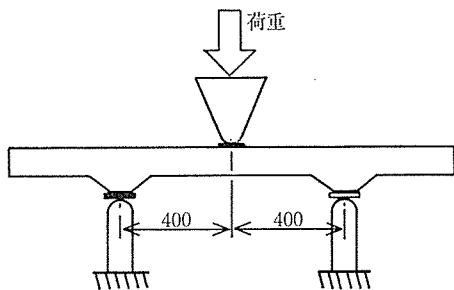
3点曲げ試験 (試験片 # 9, 10, 単位 mm)
